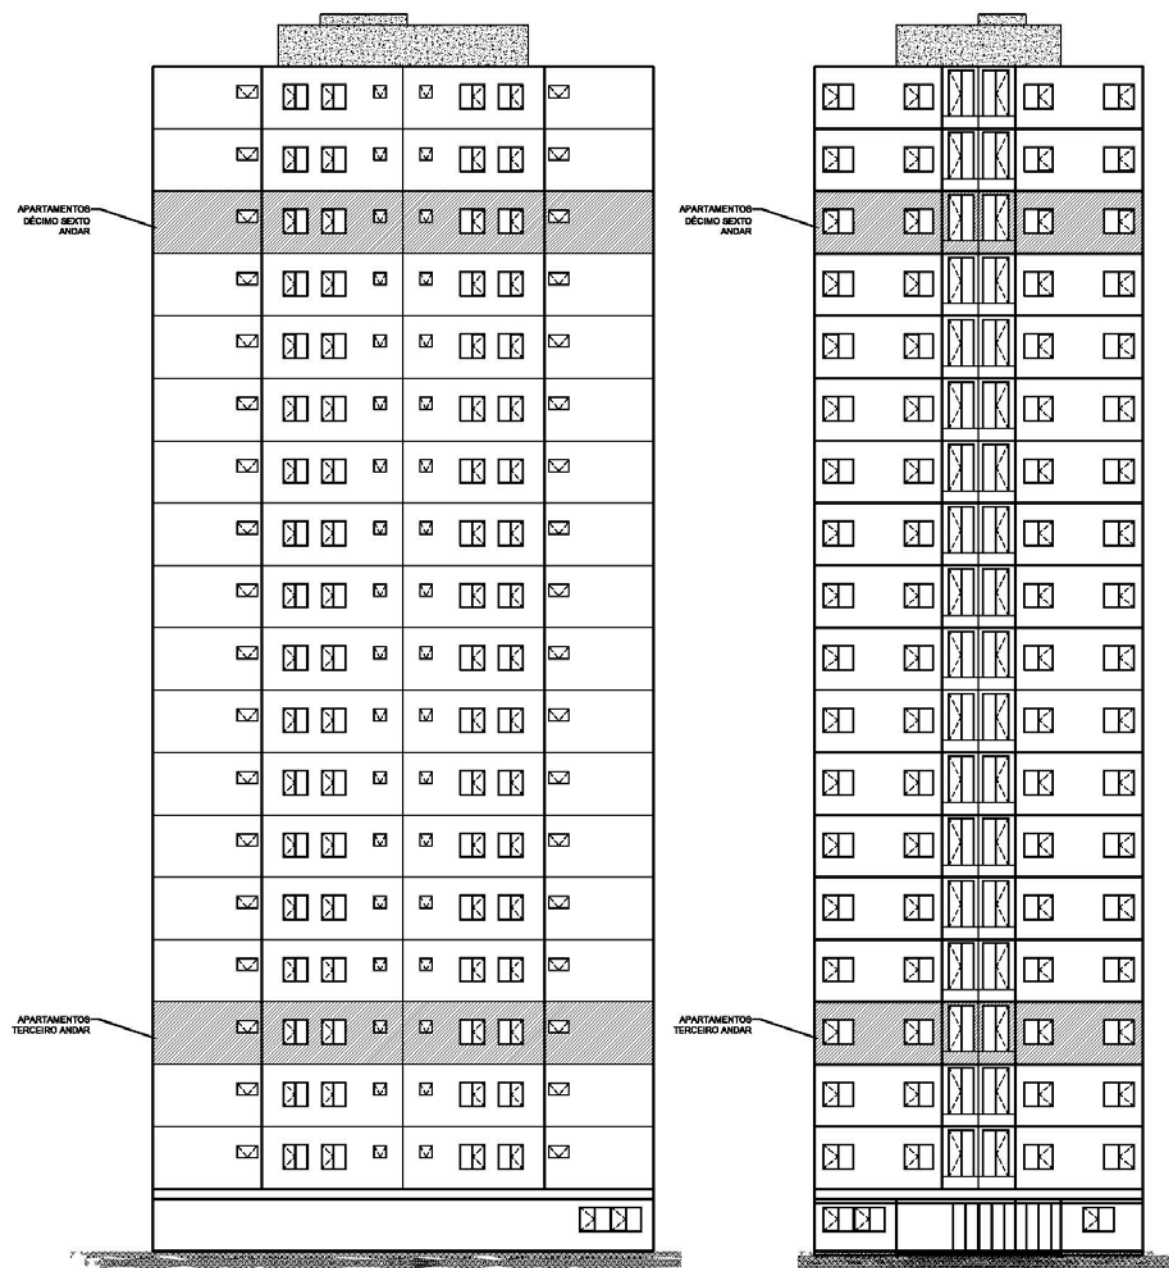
Elevação Lateral e Frontal da edificação de estudo.
